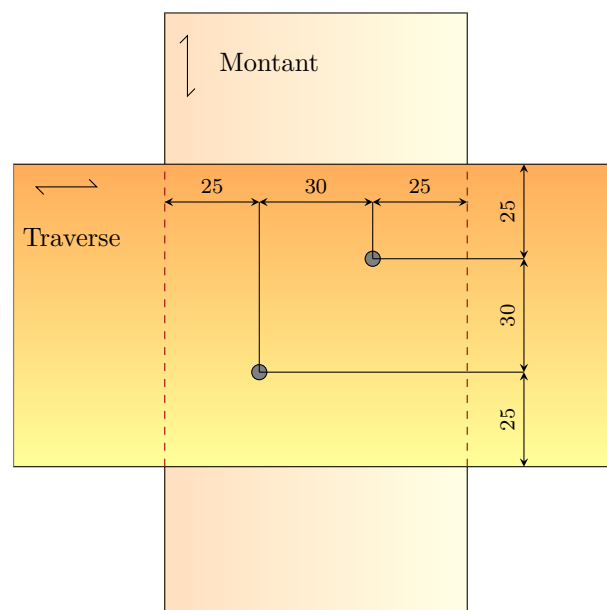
Disposition des vis acier pour chaque assemblage
